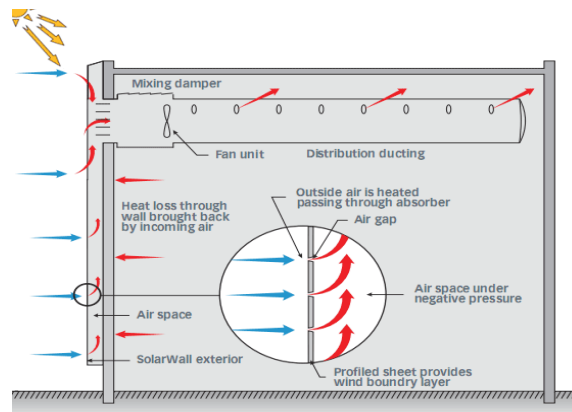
Схема руху повітря в будинку із сонячними панелями для нагрівання повітря MatrixAir™ Backpass (Канада).
